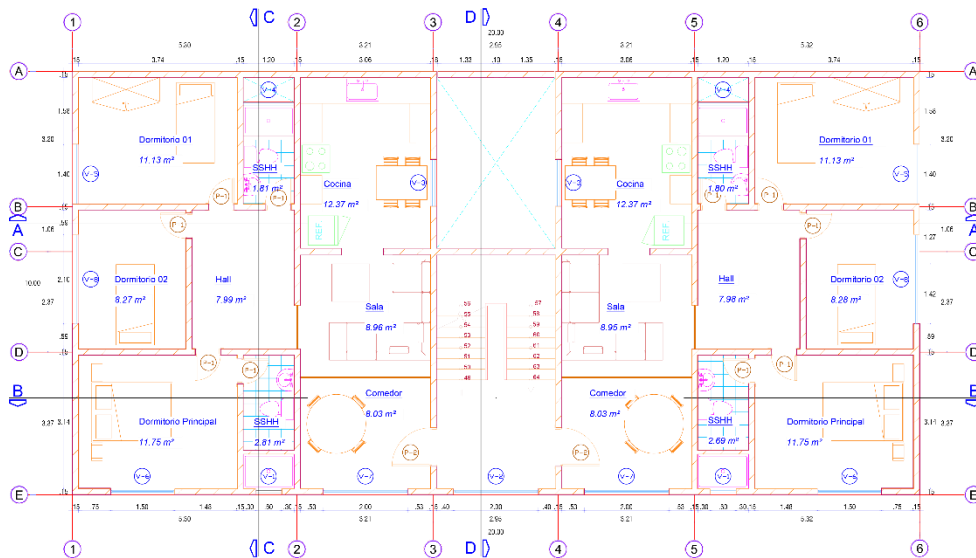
Plano Arquitectónico de la Distribución de Planta del 2º - 4º Nivel.
